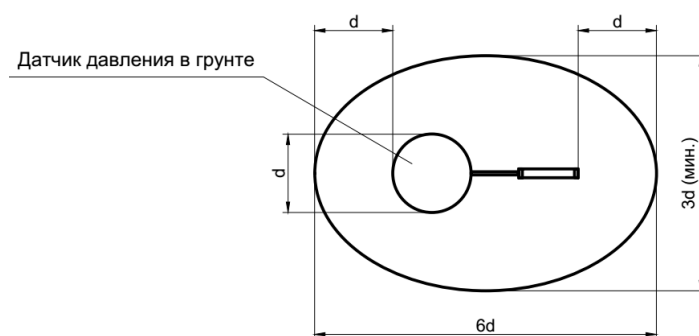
Карман закладки датчика давления грунта. Вид в плане
